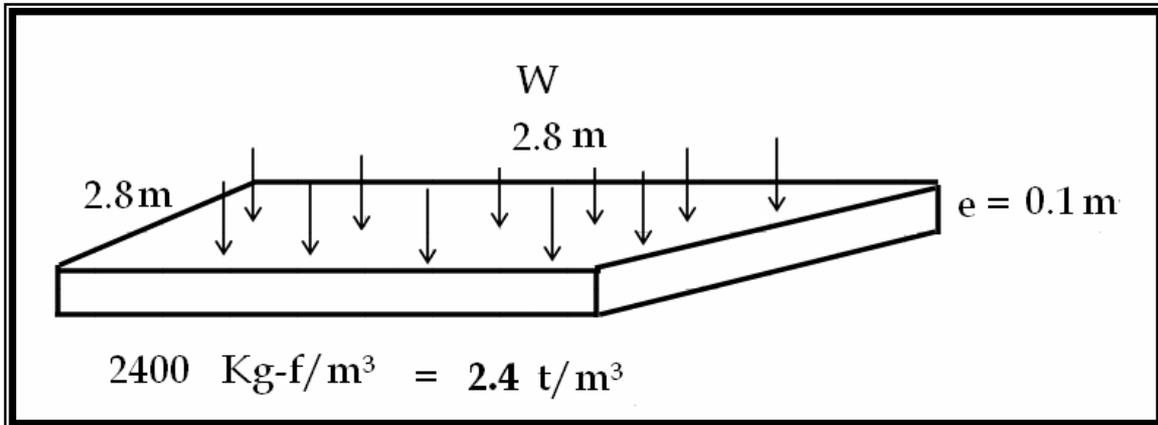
Diseño de la Placa de la Cubierta – Tanque de almacenamiento
